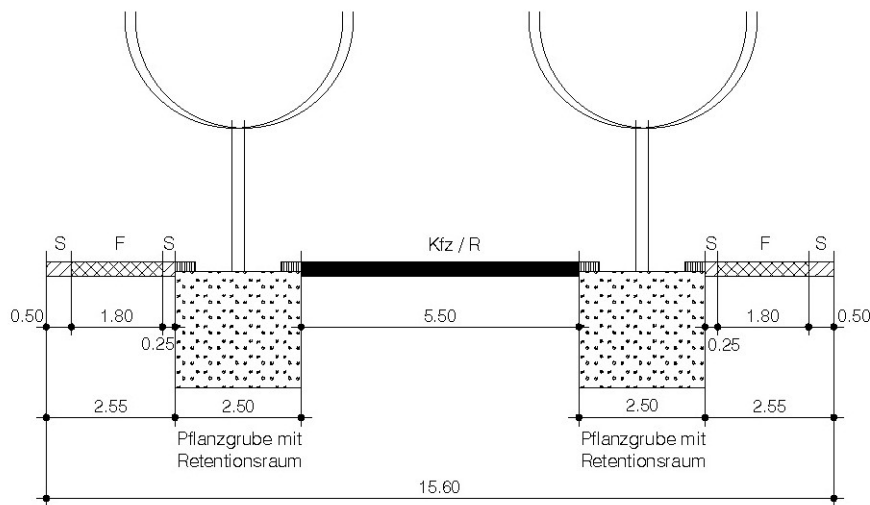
empfohlener Straßenquerschnitt für die Planstraßen „B“ und „D“
